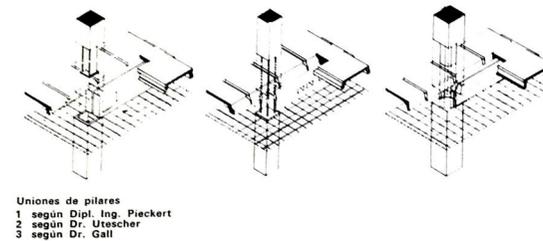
ejemplo de sistema de vigas y columnas prefabricadas en hormigón (Walter Meyer - Bohe 1969)
